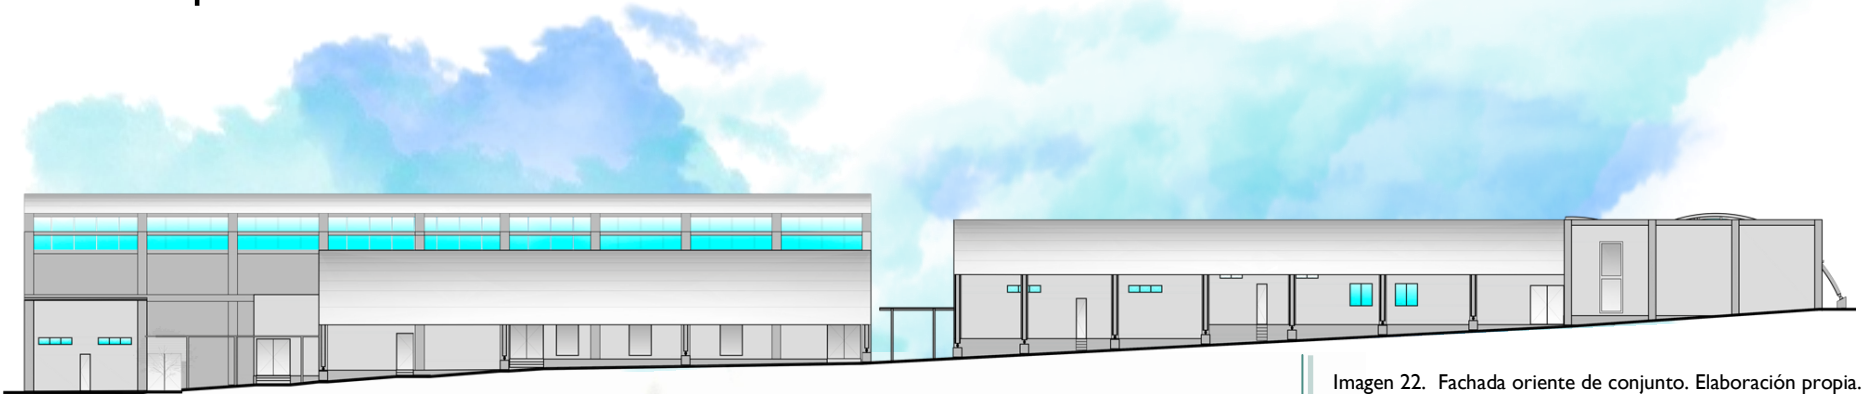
Fachada oriente de conjunto. Elaboración propia.
